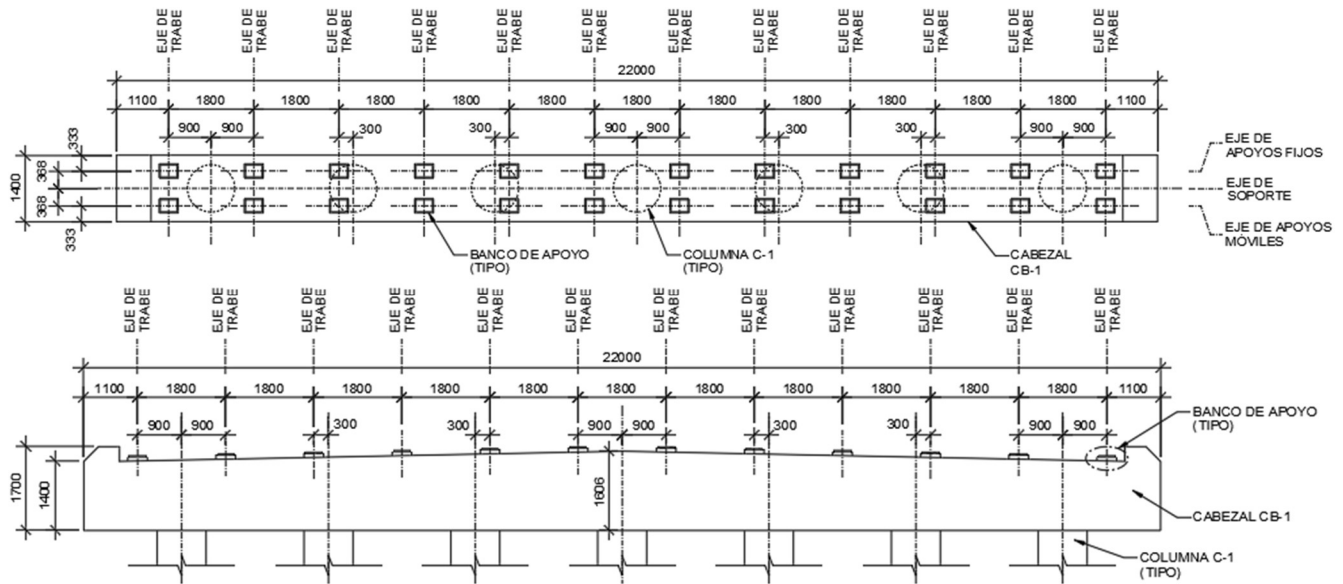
Vista en planta y elevación del cabezal CB-1, para marcos M-1 y M-3
